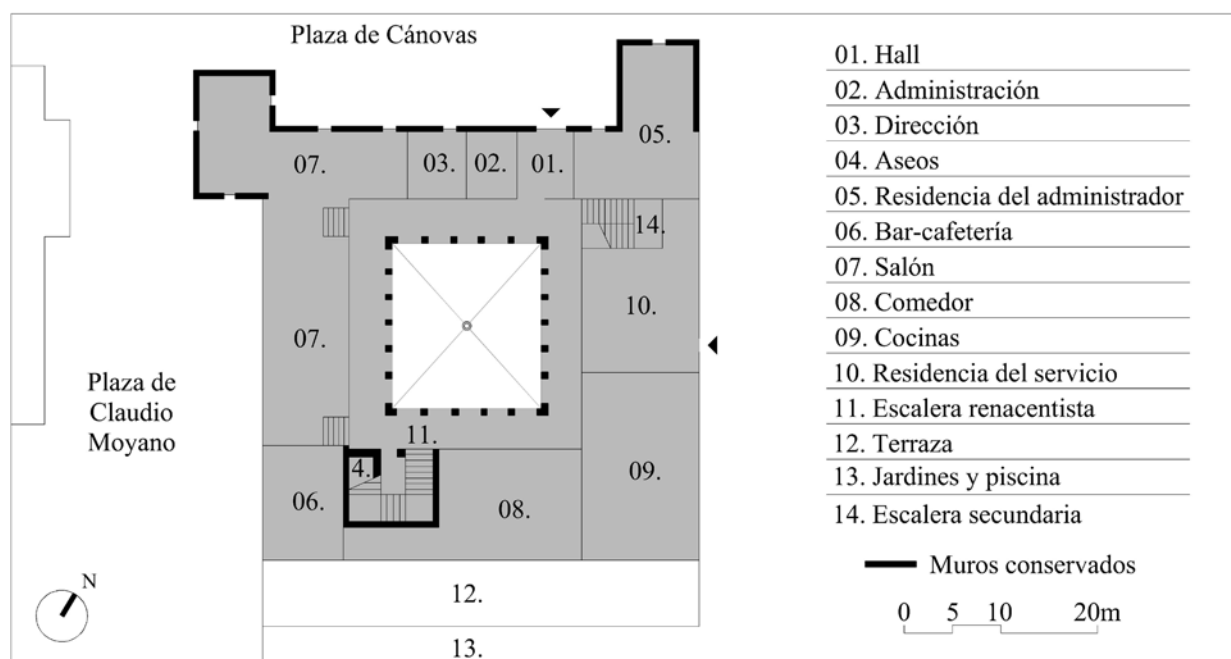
PLANTA BAJA DEL PROYECTO DEL PARADOR DE ZAMORA. (Elaboración propia basándose en el proyecto reformado de 1968, AGA, MIT, 49-23, caja 46975).
